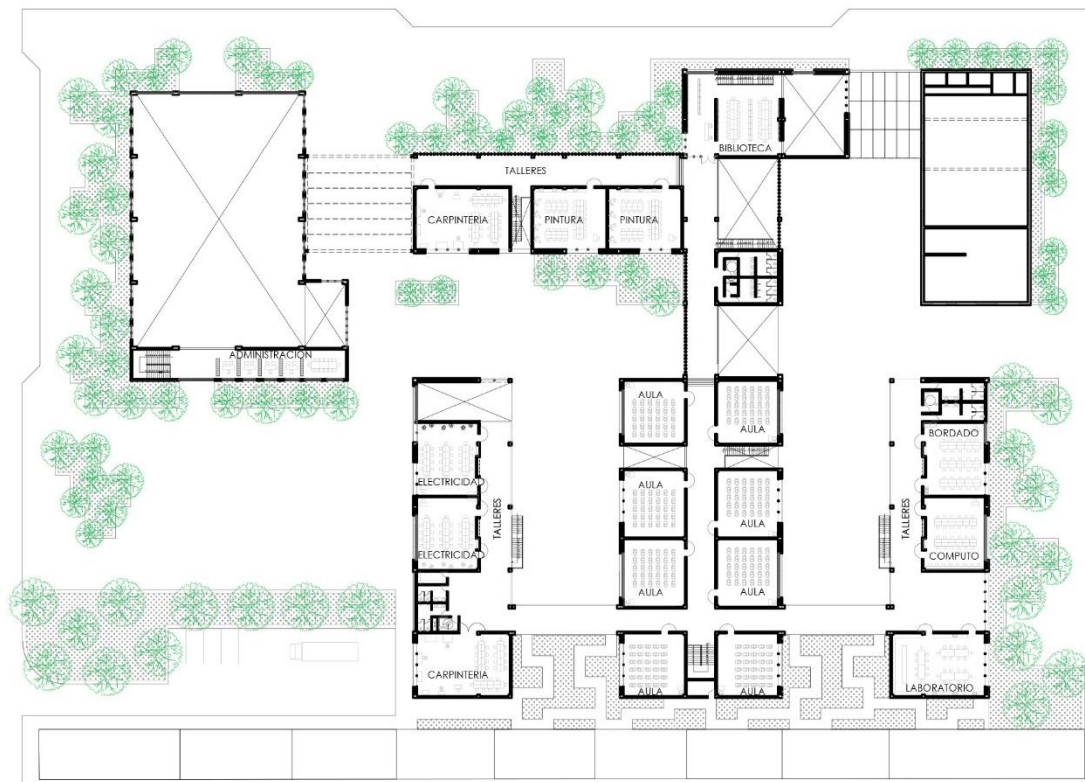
Segunda planta del colegio Diego Ferre Sosa. Fuente: Propia
